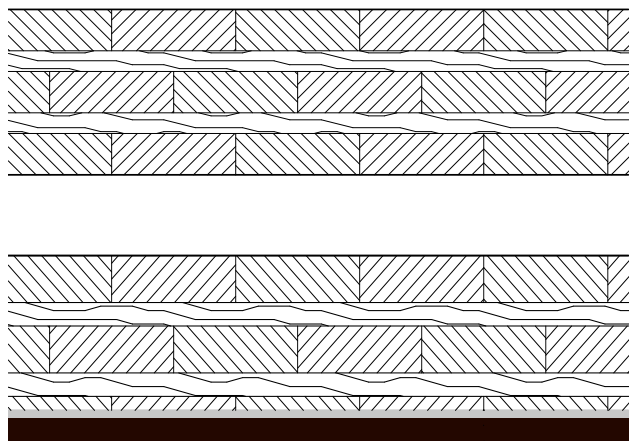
Sichtbare Holzmassivdecke, gebaute Elemente (oben) und statisch erforderliche Elementdicke nach 30 Minuten Abbrand (unten).
